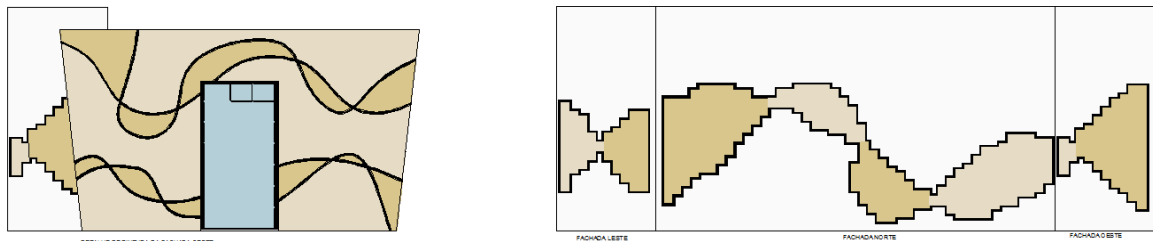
Fachada Sul – proposta arquitetônica.
